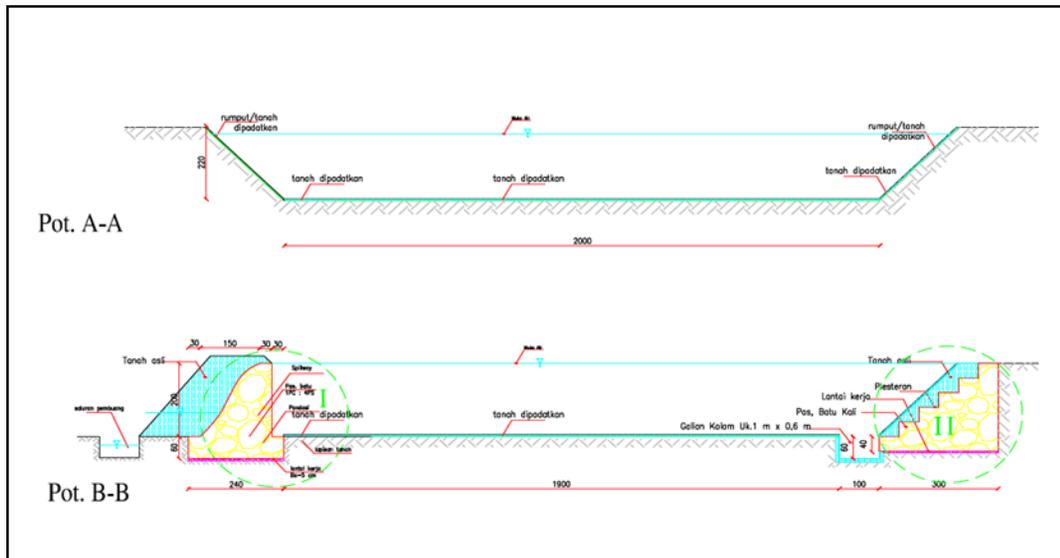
Detail *spillway* embung air dengan bahan spesi batu
